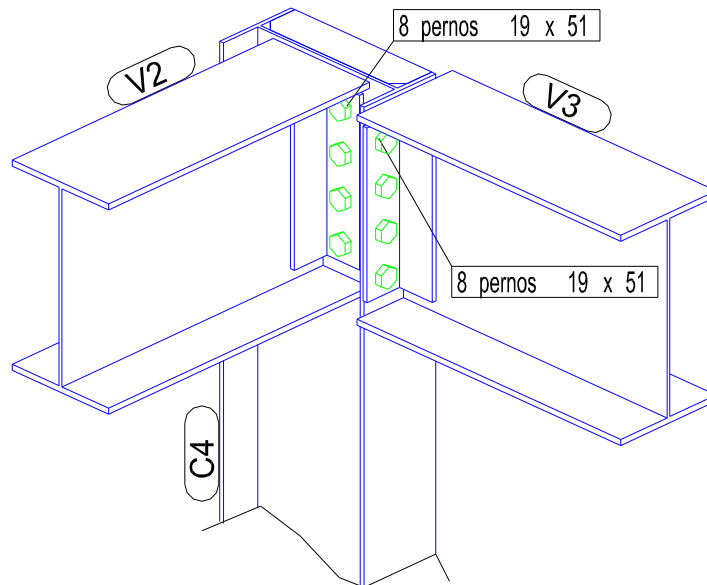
Esquema Conexión Viga IN35-Columna IN30
